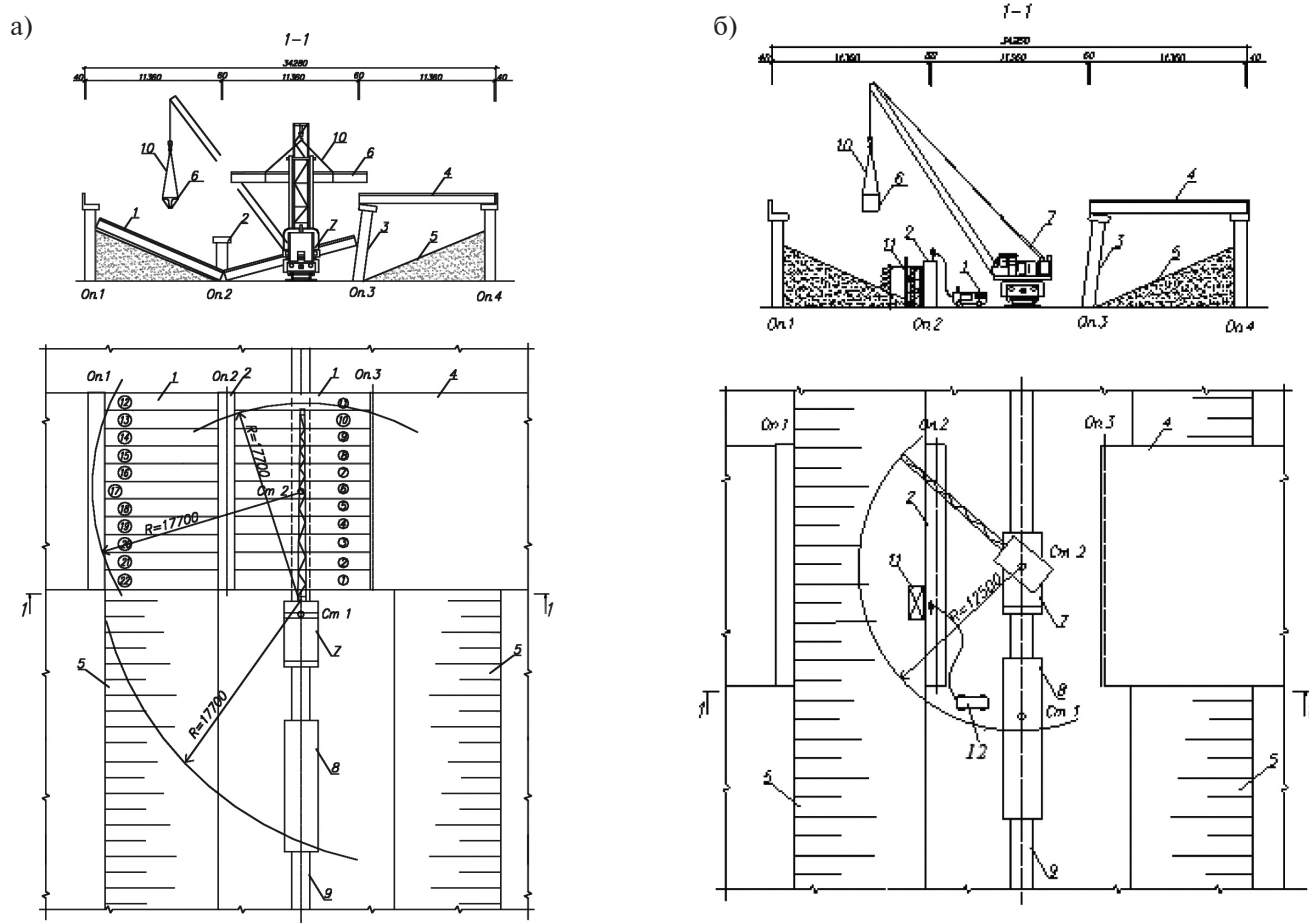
Демонтаж несущих конструкций: а) демонтаж балок пролетного строения; б) демонтаж опоры; 1 — балки обрушенных пролетов; 2 — обрушенная опора № 2; 3 — опора № 3, имеющая крен; 4 — балки пролета 3-4; 5 — откосы; 6 — демонтируемая балка (элемент); 7 — кран железнодорожный; 8 — грузовая ж/д платформа; 9 — ж/д пути; 10 — строп; 11 — подмости; 12 — компрессор; ①-②② — порядок демонтажа балок ПС
